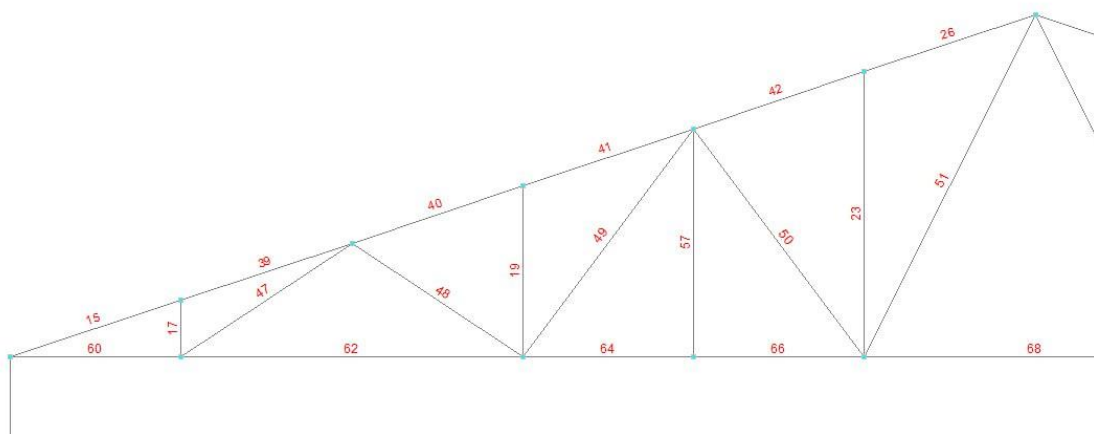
Фрагмент розрахункової схеми каркасу будівлі з нумеруванням елементів (для ферми в осях Д-Б)
